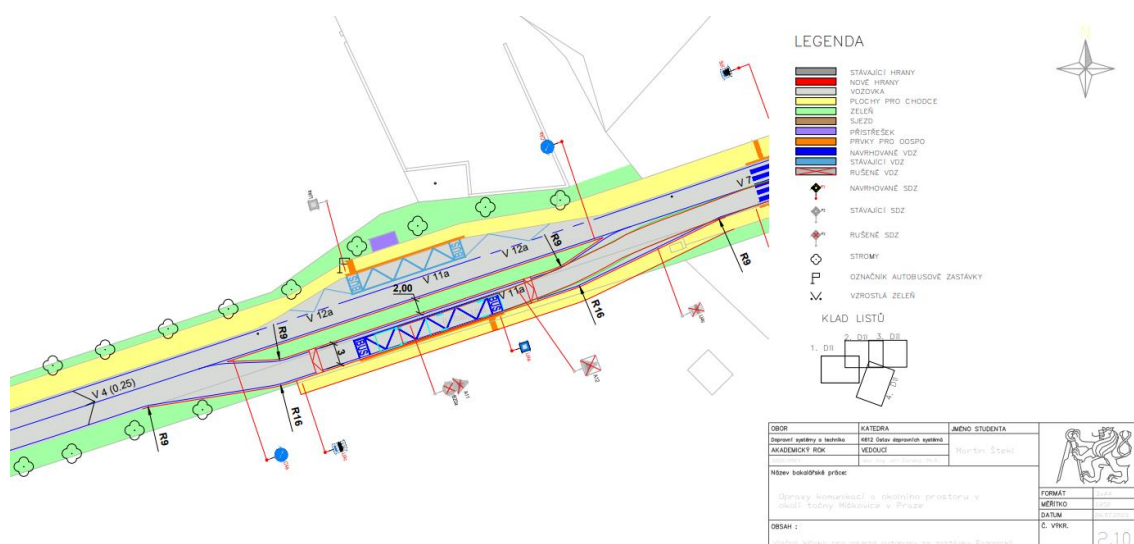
Navrhovaný stav, příloha 2.1 (zdroj: autor)
